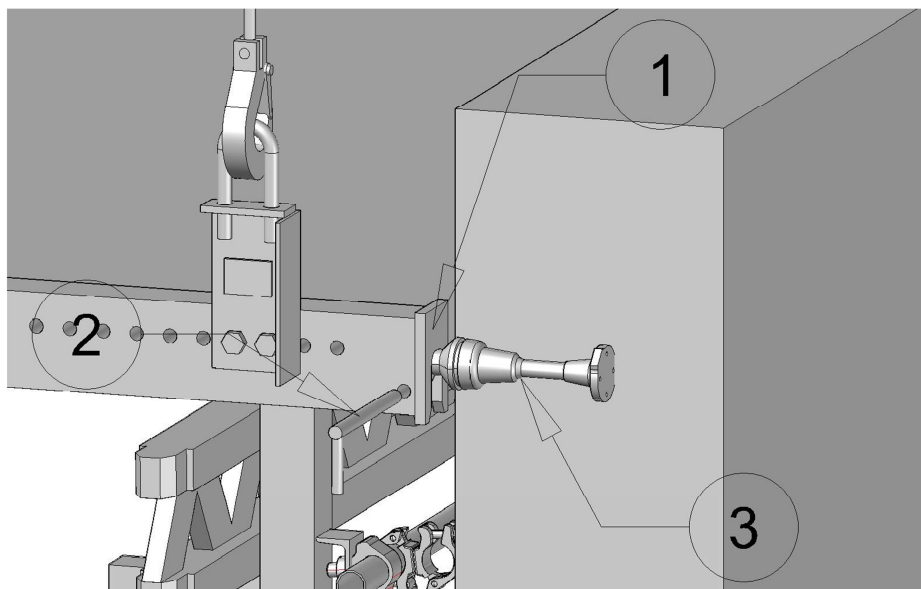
inserimento delle piastre di testa della mensola sui rocchetti dell'ancoraggio
